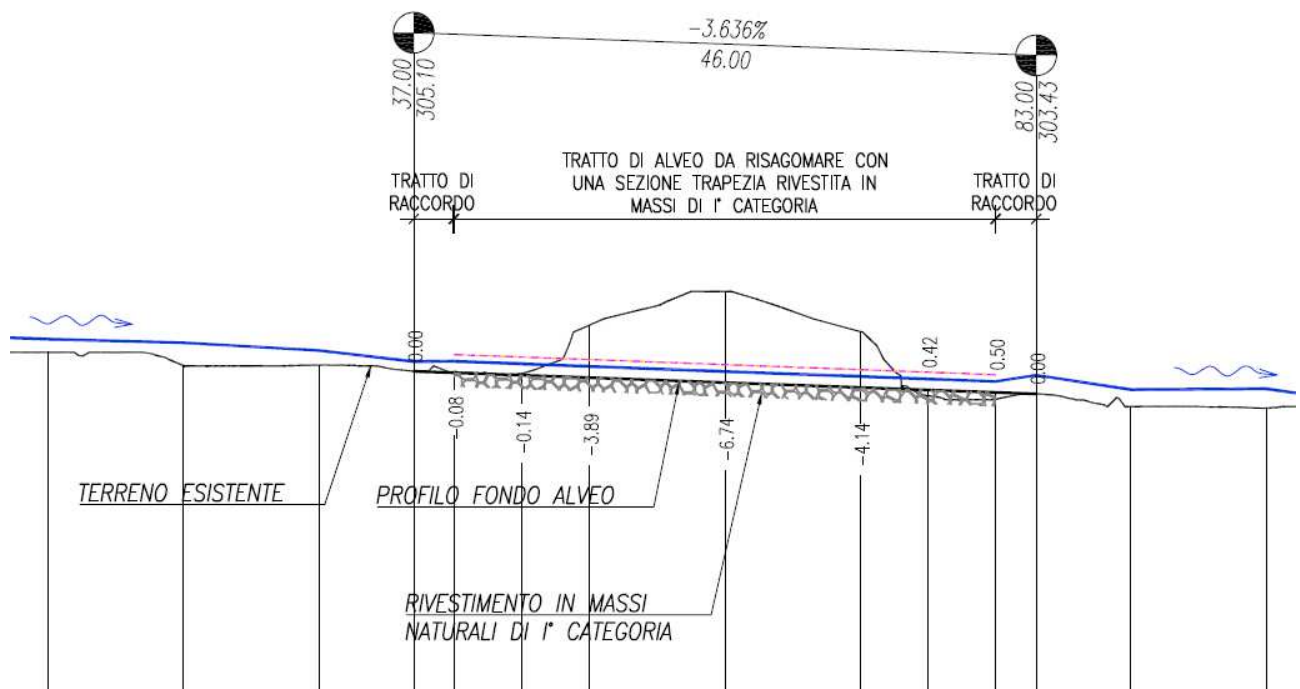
Sbarramento ST01 Valli – Profilo progetto di demolizione
